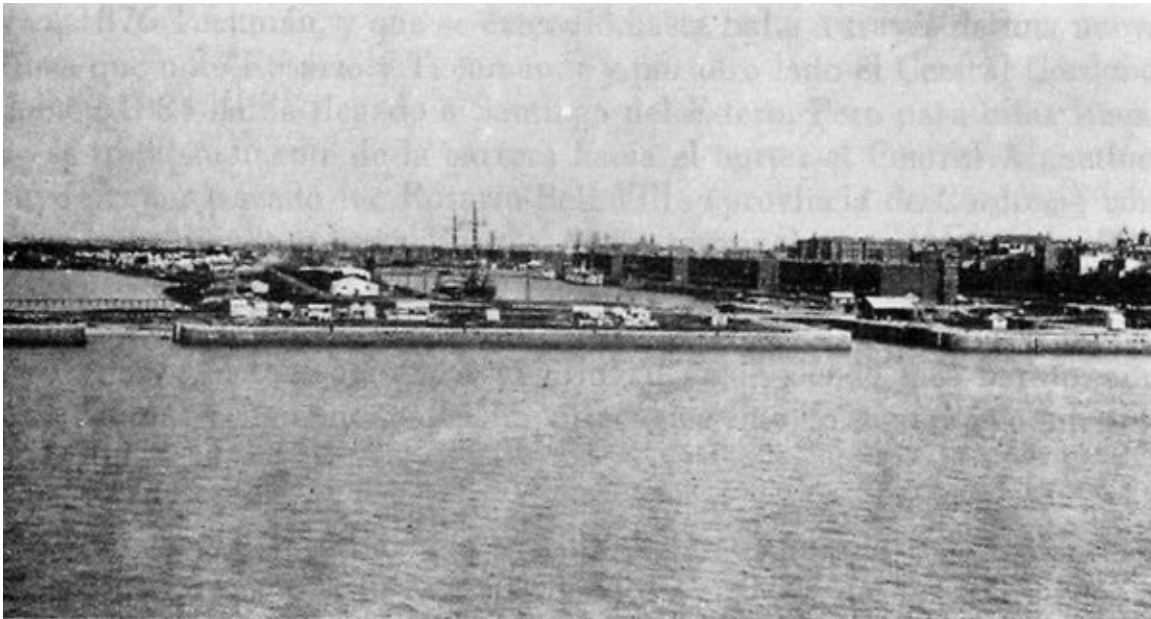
Construcción de las dársenas (Archivo General de la Nación).
